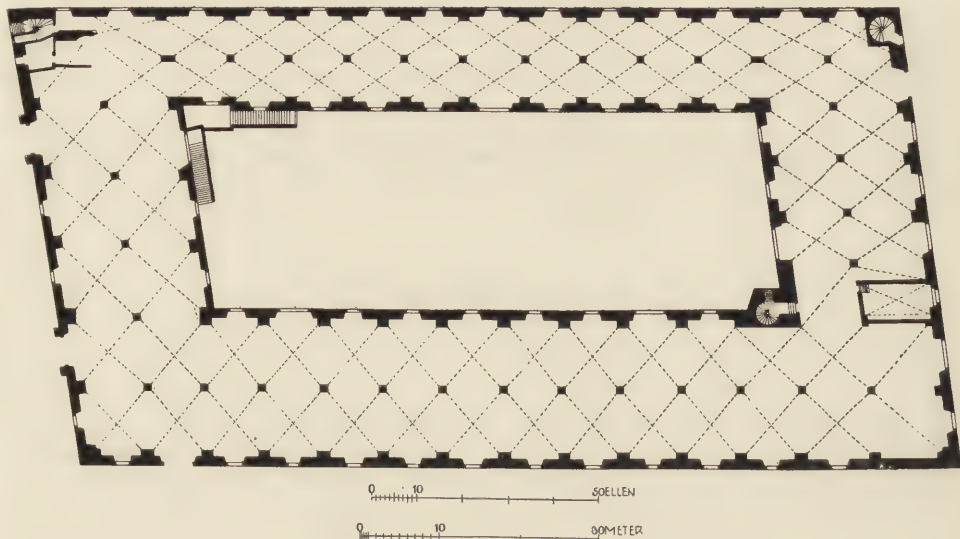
Zeughaus, Grundriss. Zustand vor 1740.
